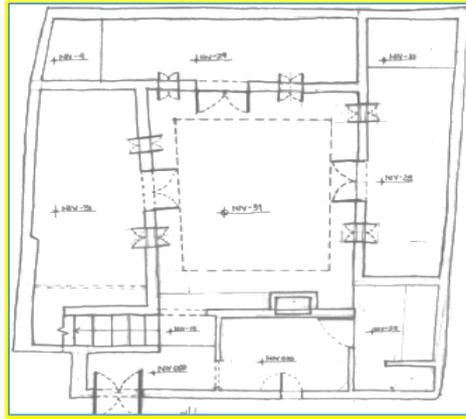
Vue en plan d'une maison traditionnelle à Alger. Source : André Ravéreau; la casbah d'Alger et le site créa la ville).
